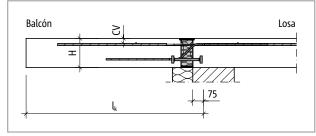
Schöck Isokorb® T tipo K-M1 hasta M11: Sistema estático
